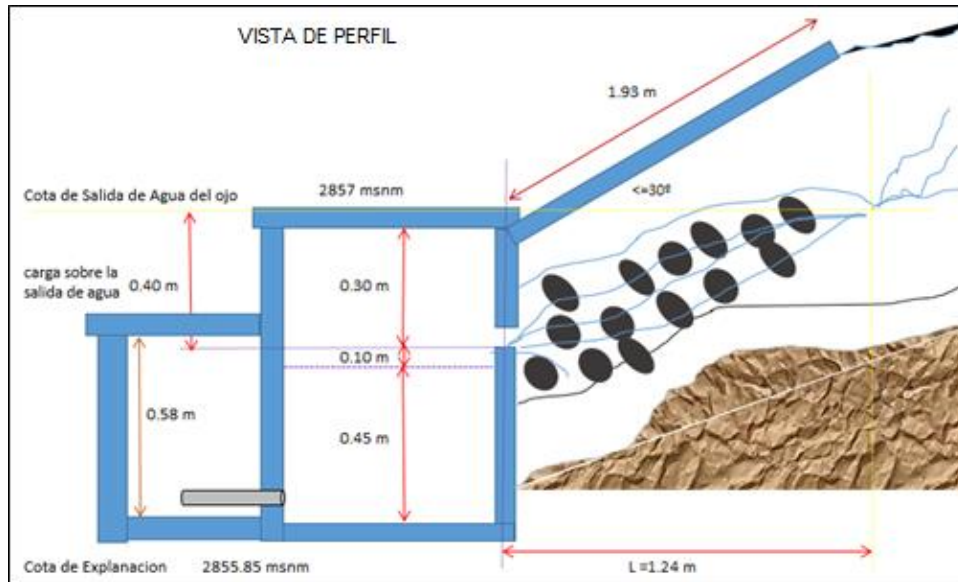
Pre dimensión hidráulica de la cámara húmeda 1
